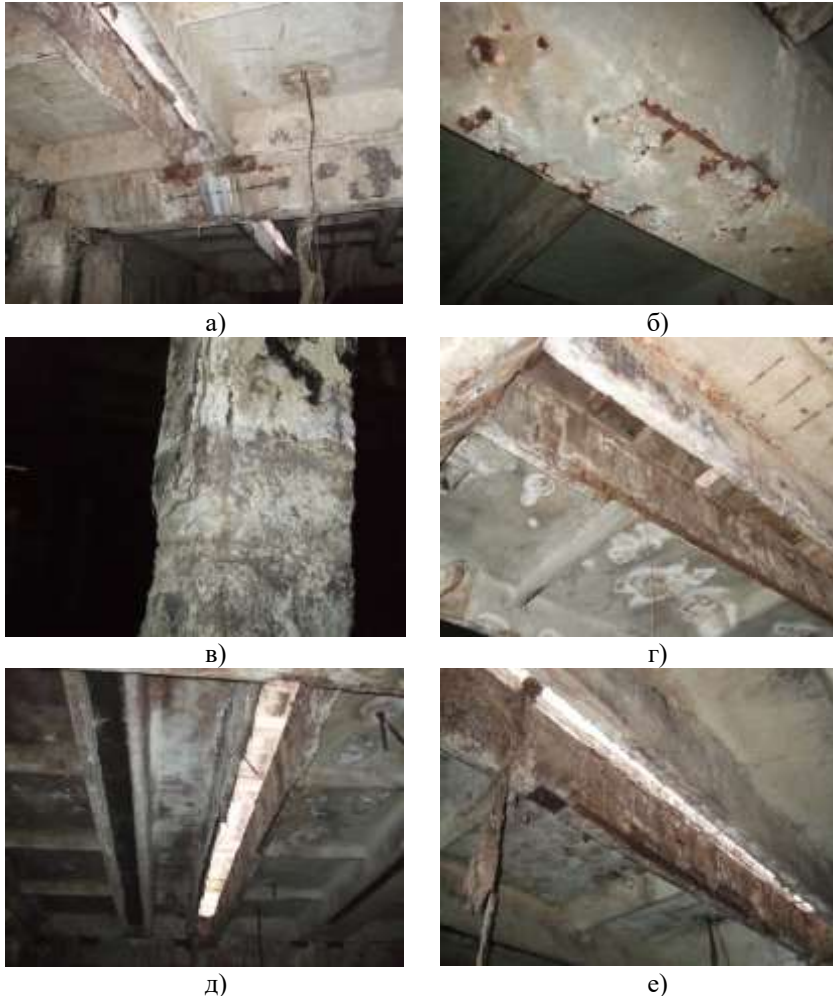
Фотофіксація місць виявлених дефектів в несучих конструкціях надпідвального перекриття: а), б) корозія бетону та армування в збірних залізобетонних ригелях; в) корозія бетону в колонах; г), д), е) корозія бетону та армування в ребристих плитах в зоні прорізів для стікання ґною
